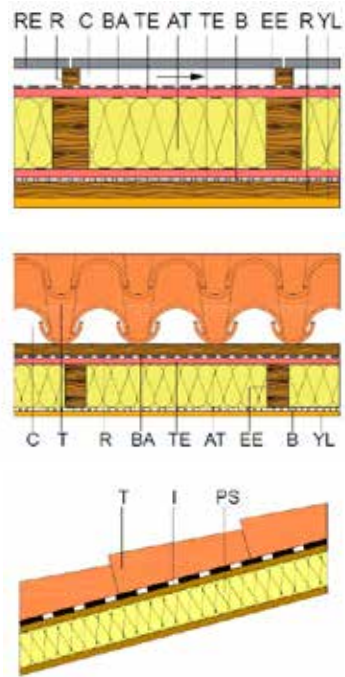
Ejemplos de fachada y cubiertas de madera del Catálogo de Elementos Constructivos (<https://itec.cat/cec/>).
